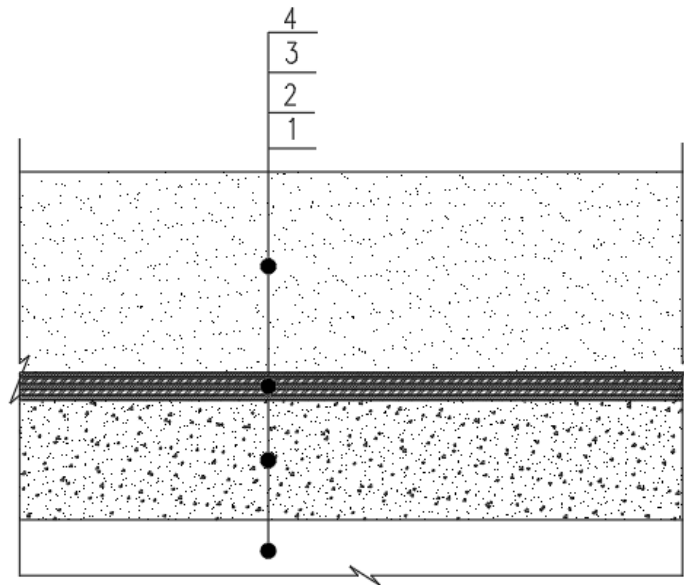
混凝土桥面板采用防水涂料防水层结构示意图
